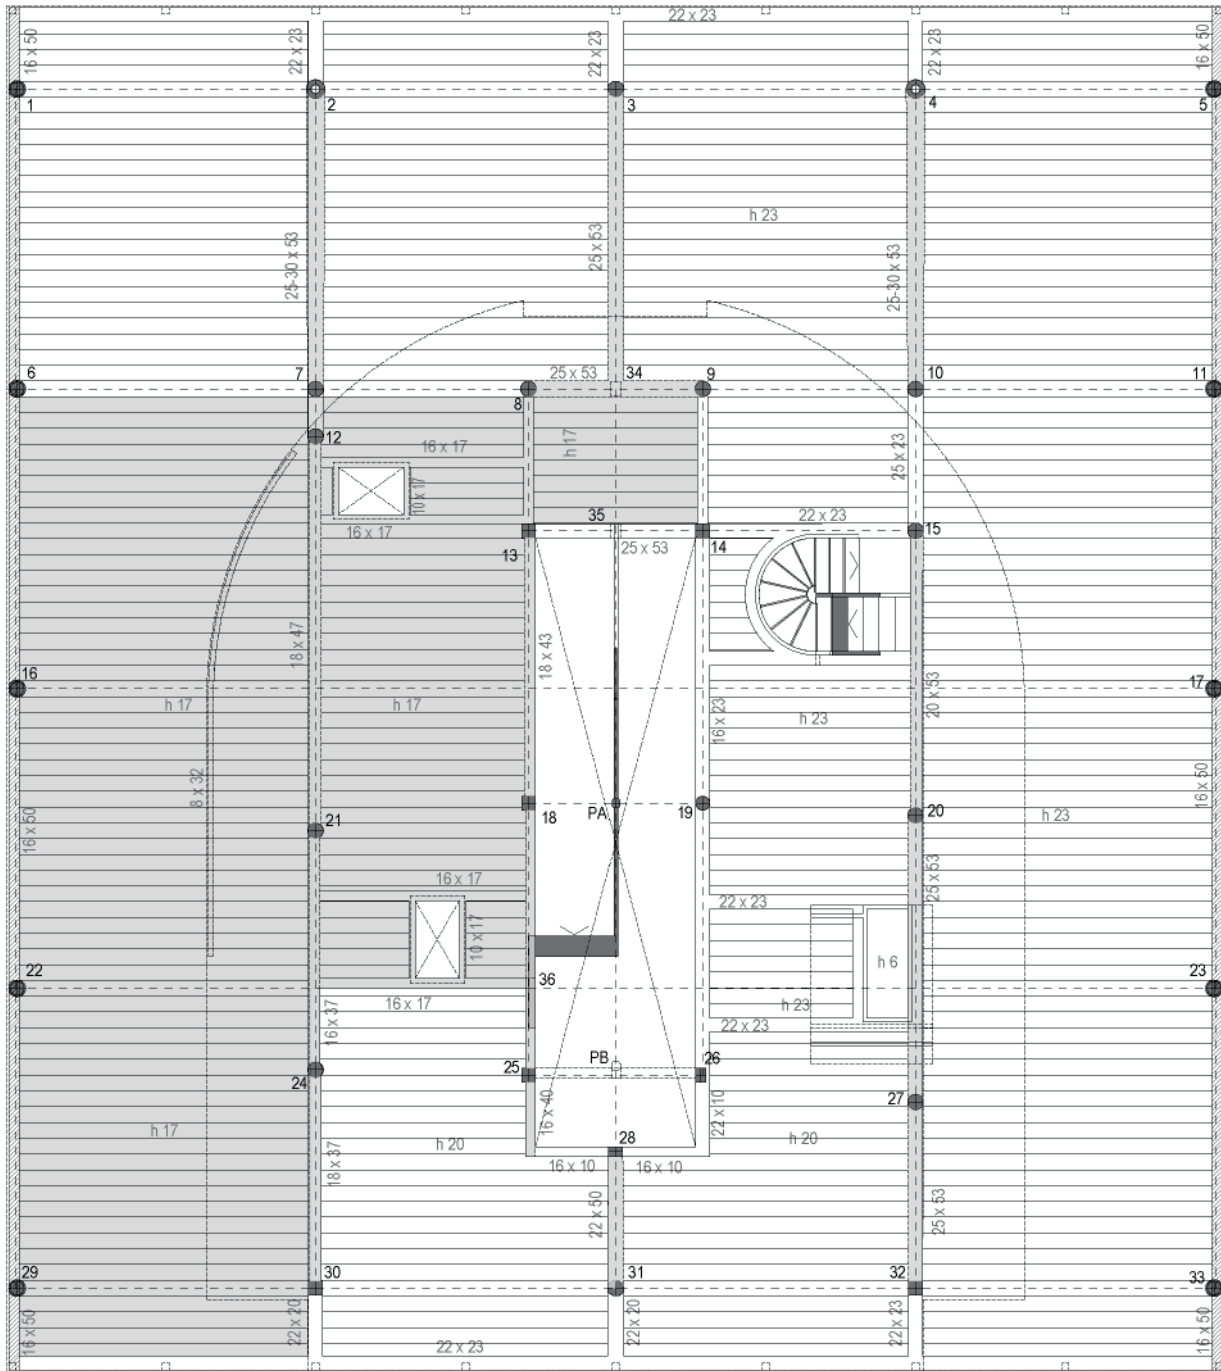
Plano del forjado de techo de planta baja de la Villa Savoye a escala 1:50 . Elaboración propia.
